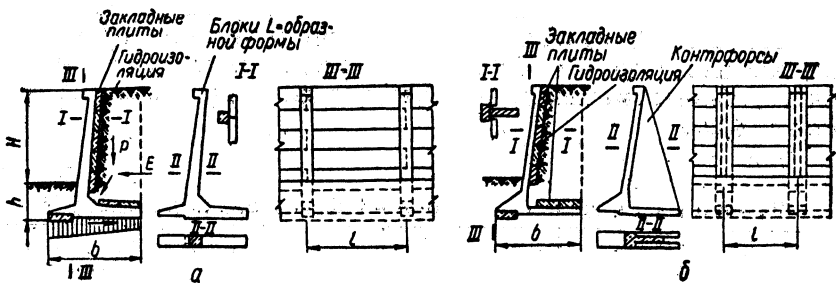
Сборные железобетонные подпорные стенки, монтируемые из:
